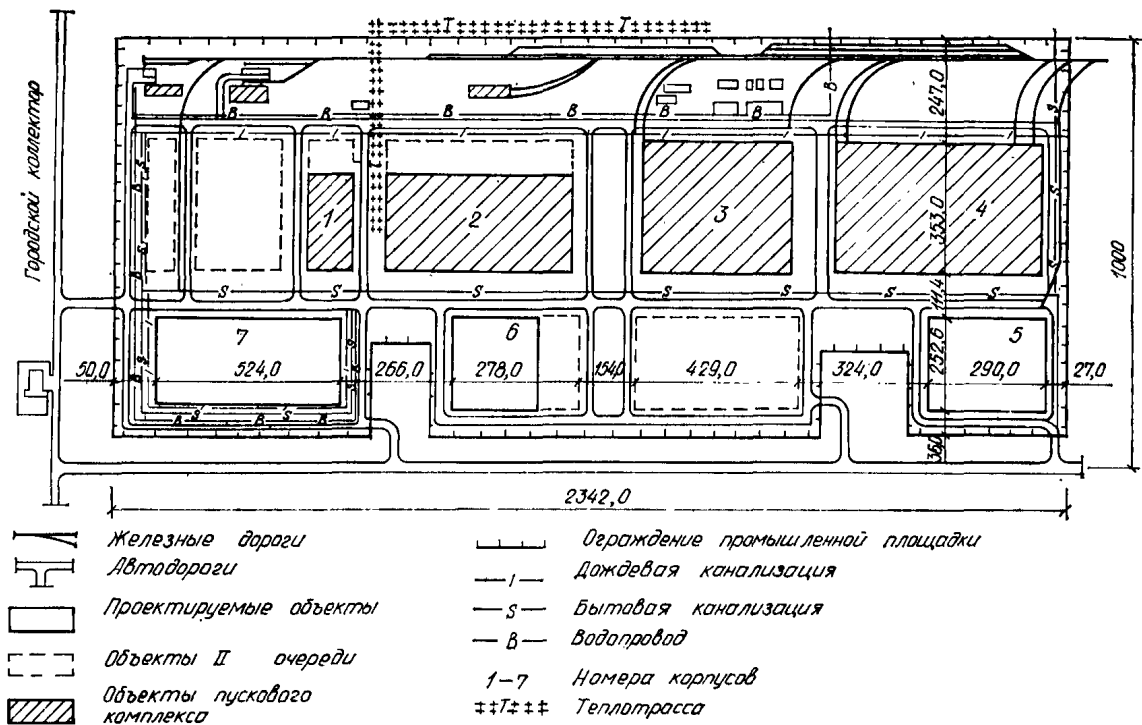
Схема генерального плана промышленной площадки 1—7 — корпус № 1—7
